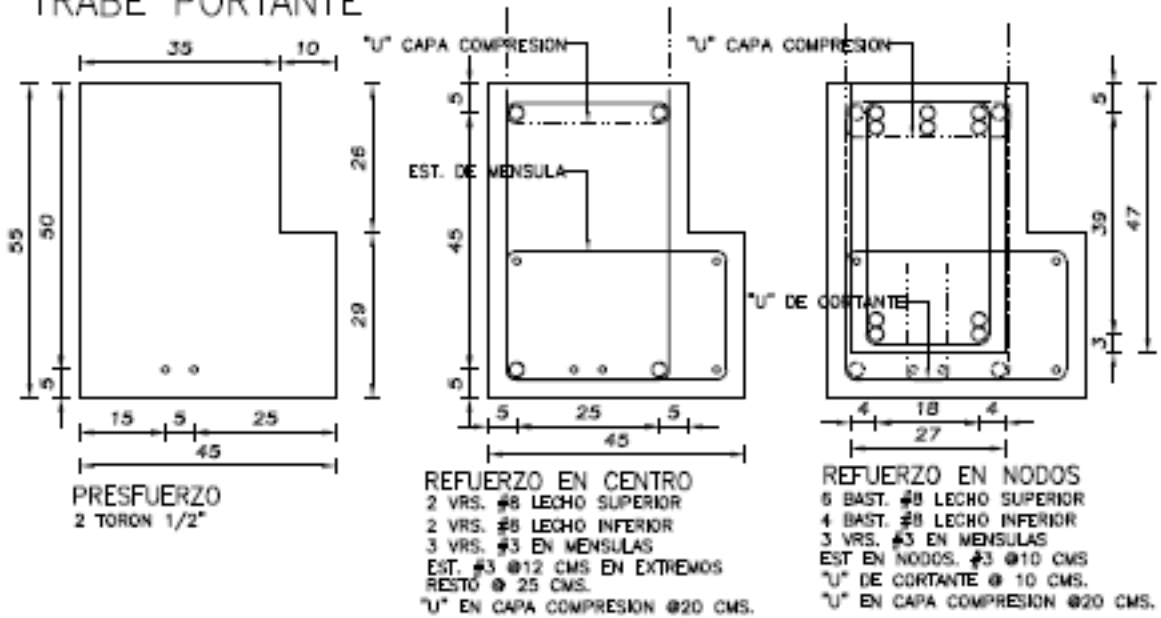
Armado de traves rigilizantes y portantes laterales en el prototipo base fija
